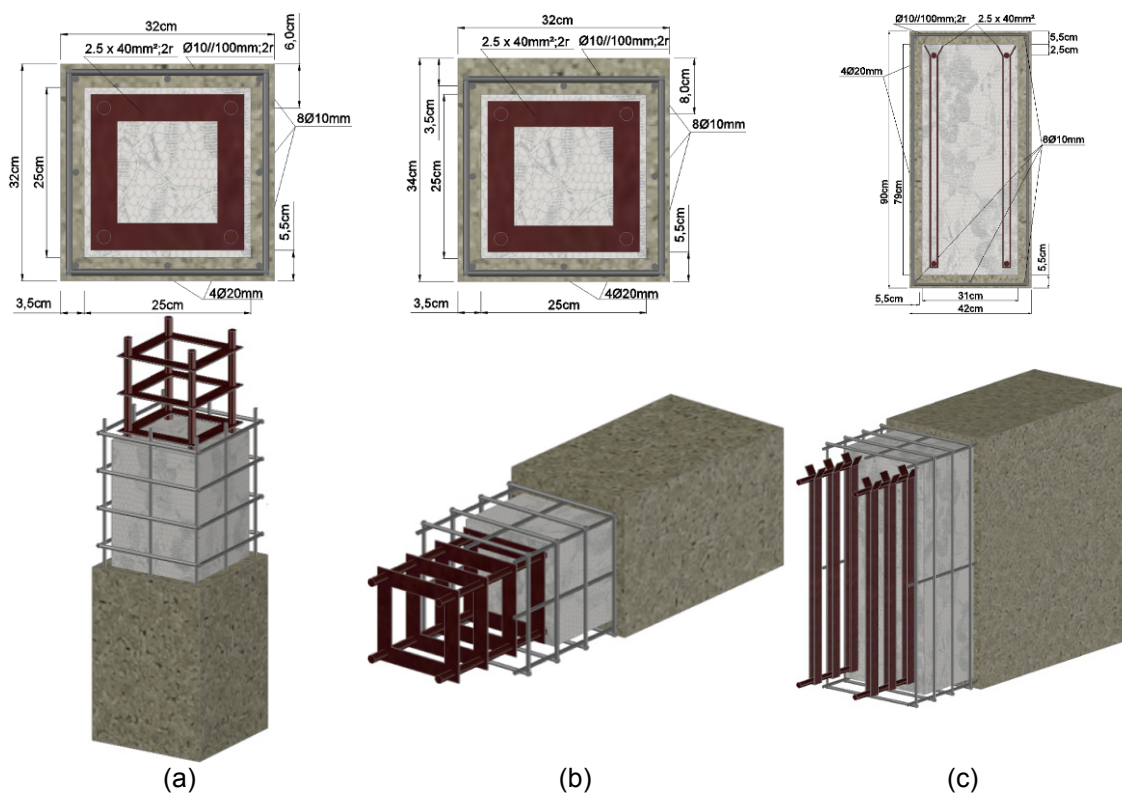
Pormenorização das armaduras com base no levantamento efectuado: (a) pilar tipo; (b) viga entre pilares; (c) arco.
